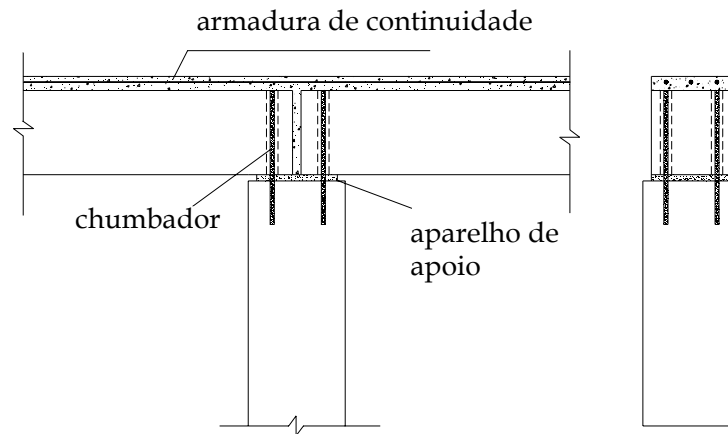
Ligação viga-pilar ensaiada no CERIB (1992) (tipo 1).
